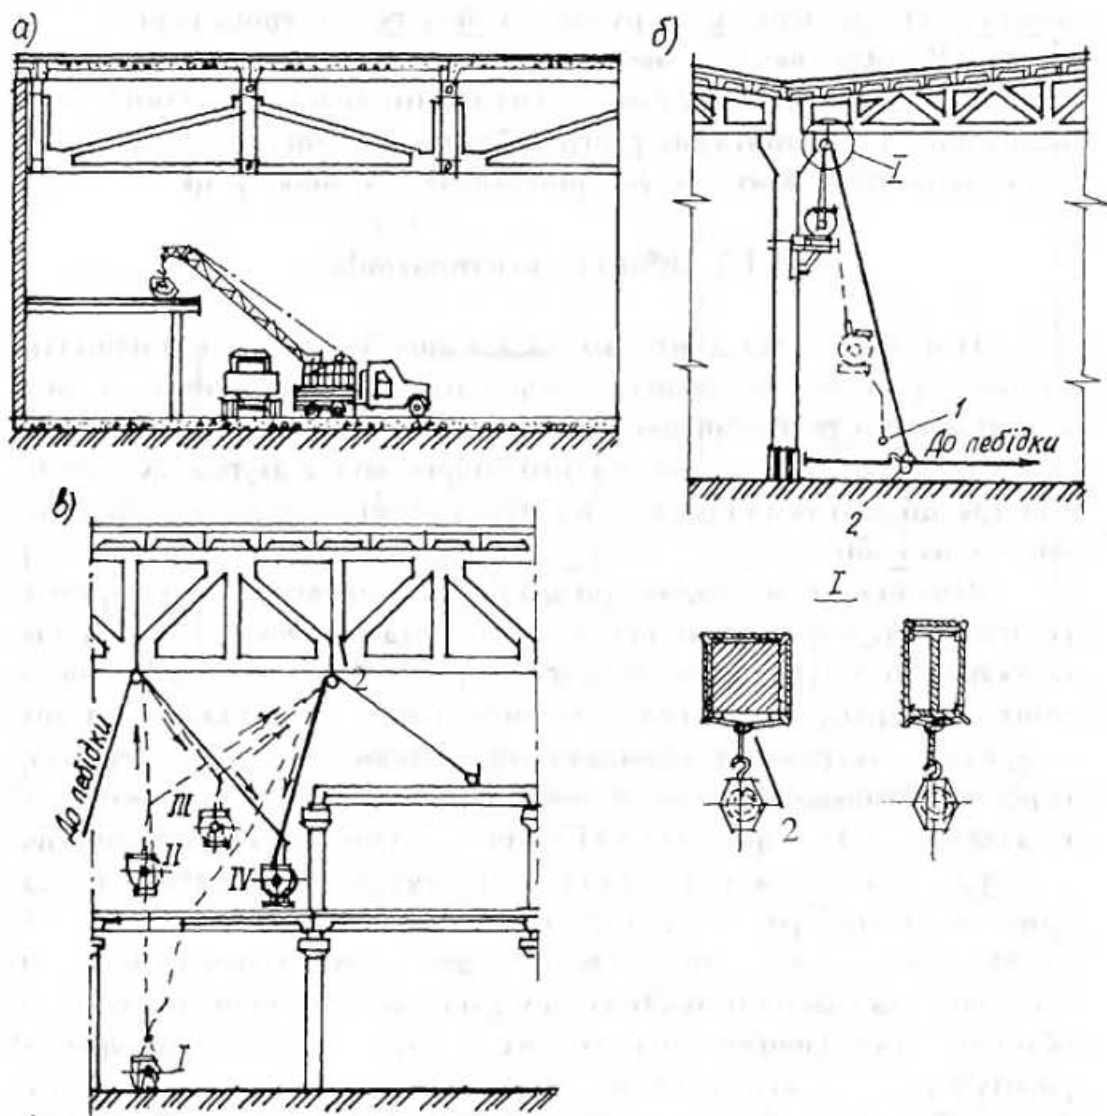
Схеми монтажу вентилятора автокраном а), однією б) і двома лебідками в): I...IV - положення вентилятора під час монтажу; 1 - відтяжка; 2 - відповідний блок
